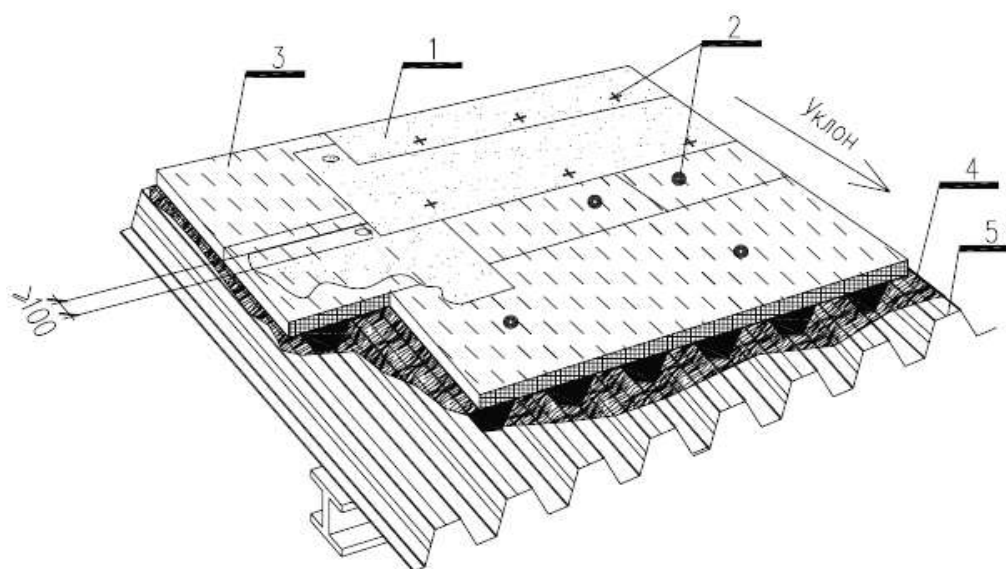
Кровля с однослойным водоизоляционным ковром по стальному профилированному настилу: 1 – однослойный водоизоляционный ковер; 2 – дюбели-саморезы для крепления водоизоляционного ковра и теплоизоляции к стальному профилированному настилу; 3 – теплоизоляция из жестких минераловатных плит; 4 – пароизоляция; 5 – стальной профилированный настил
